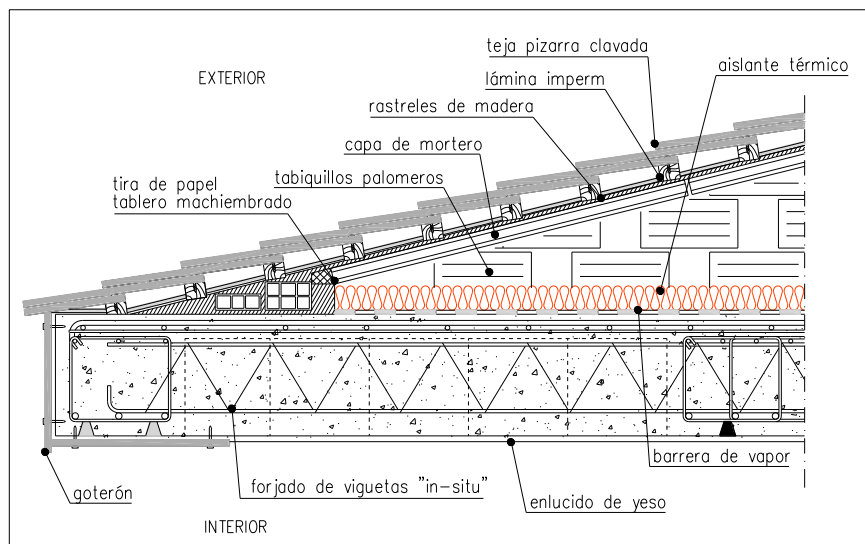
Detalle constructivo cubierta sobre tabiquillos
